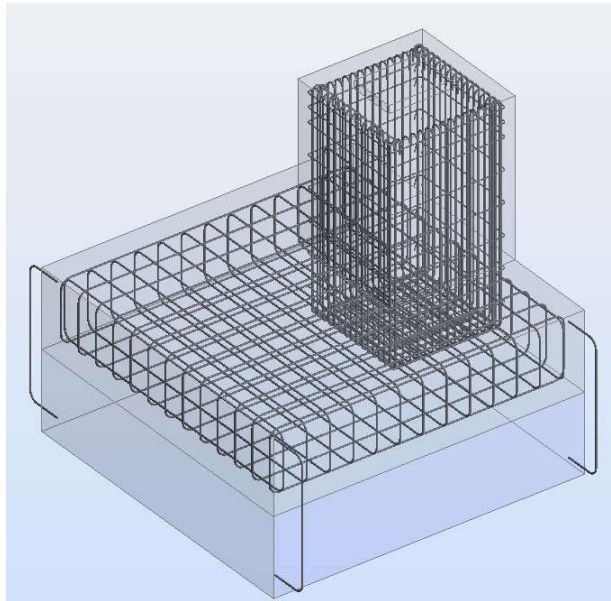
Vue en 3D de ferrailage de la semelle
